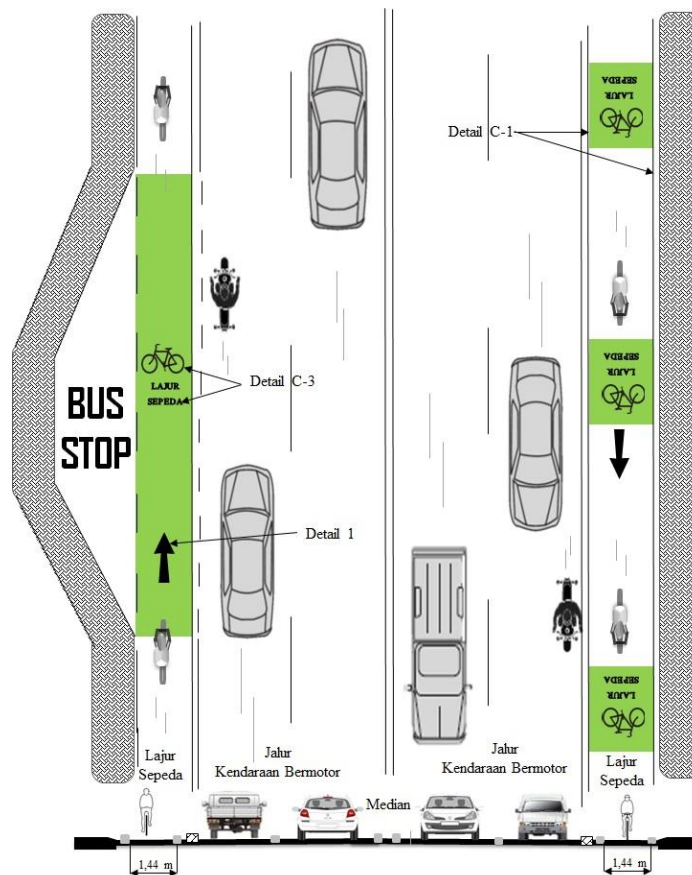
Tampak atas lajur sepeda tipe C di ruas jalan 4/2 TT
